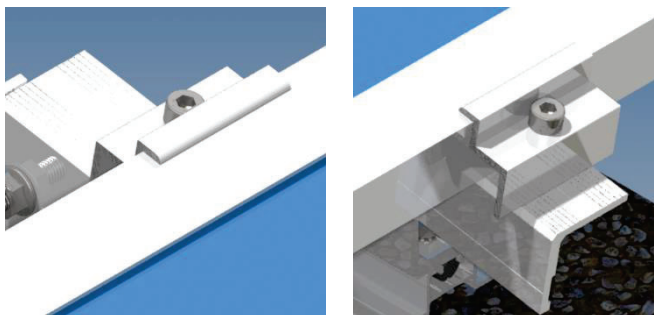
Detalle Brida Extremo para la fijación de las placas fotovoltaicas
